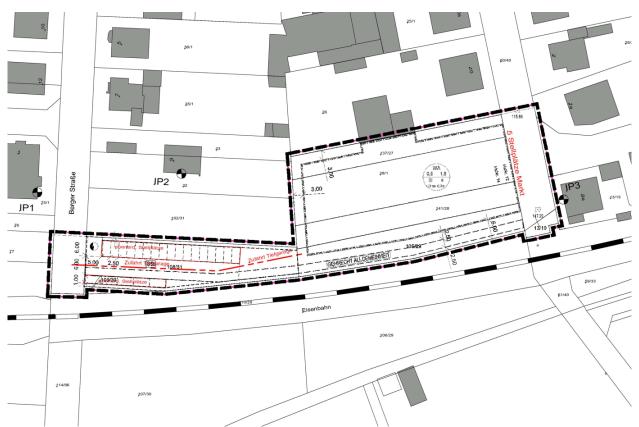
Lageplan mit der vorgesehenen Lage der Stellplätze und den Immissionsorten IP1 und IP2, unmaßstäblich
